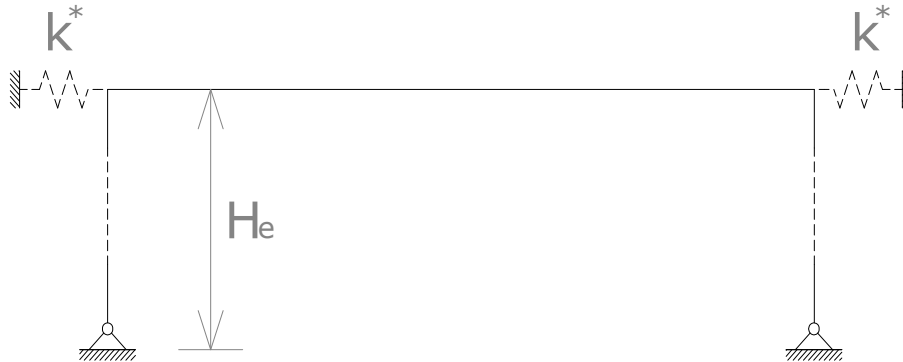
Telaio modificato al fine di considerare il contributo del terreno
